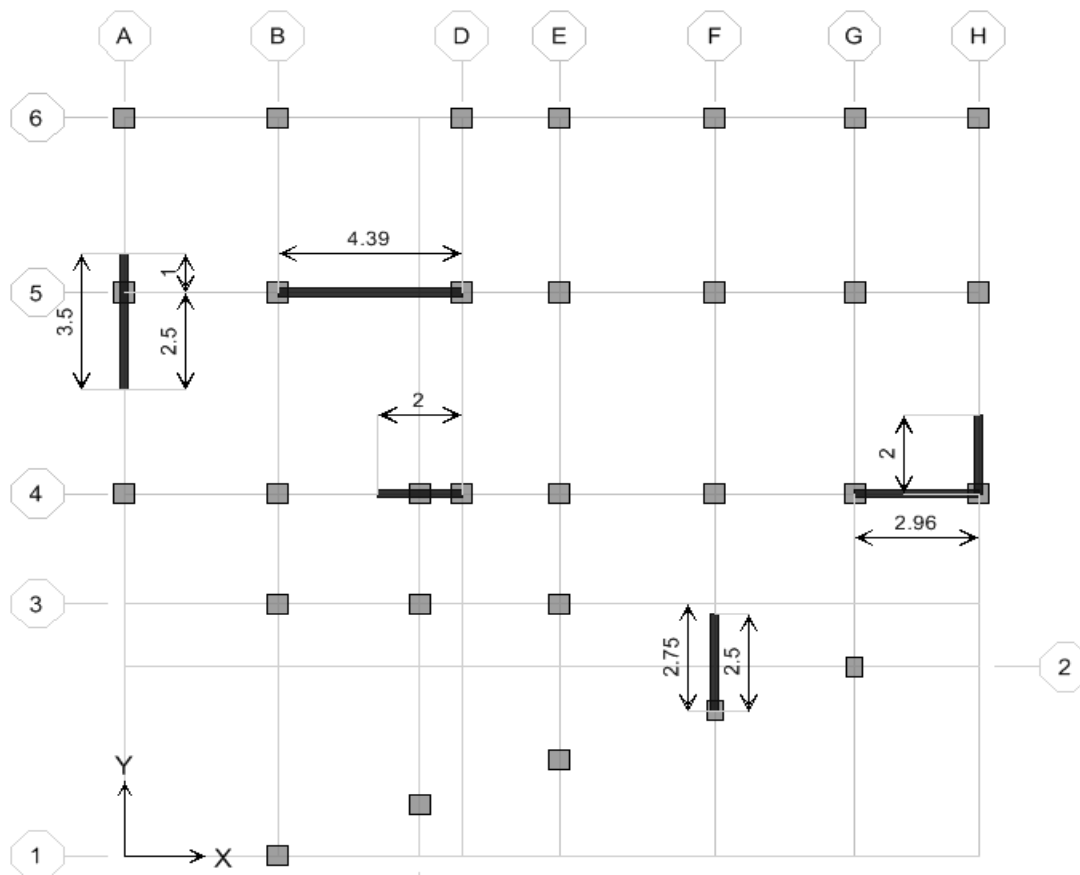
Vue en plan des éléments structuraux (Poteaux - Voiles) de la super – structure
